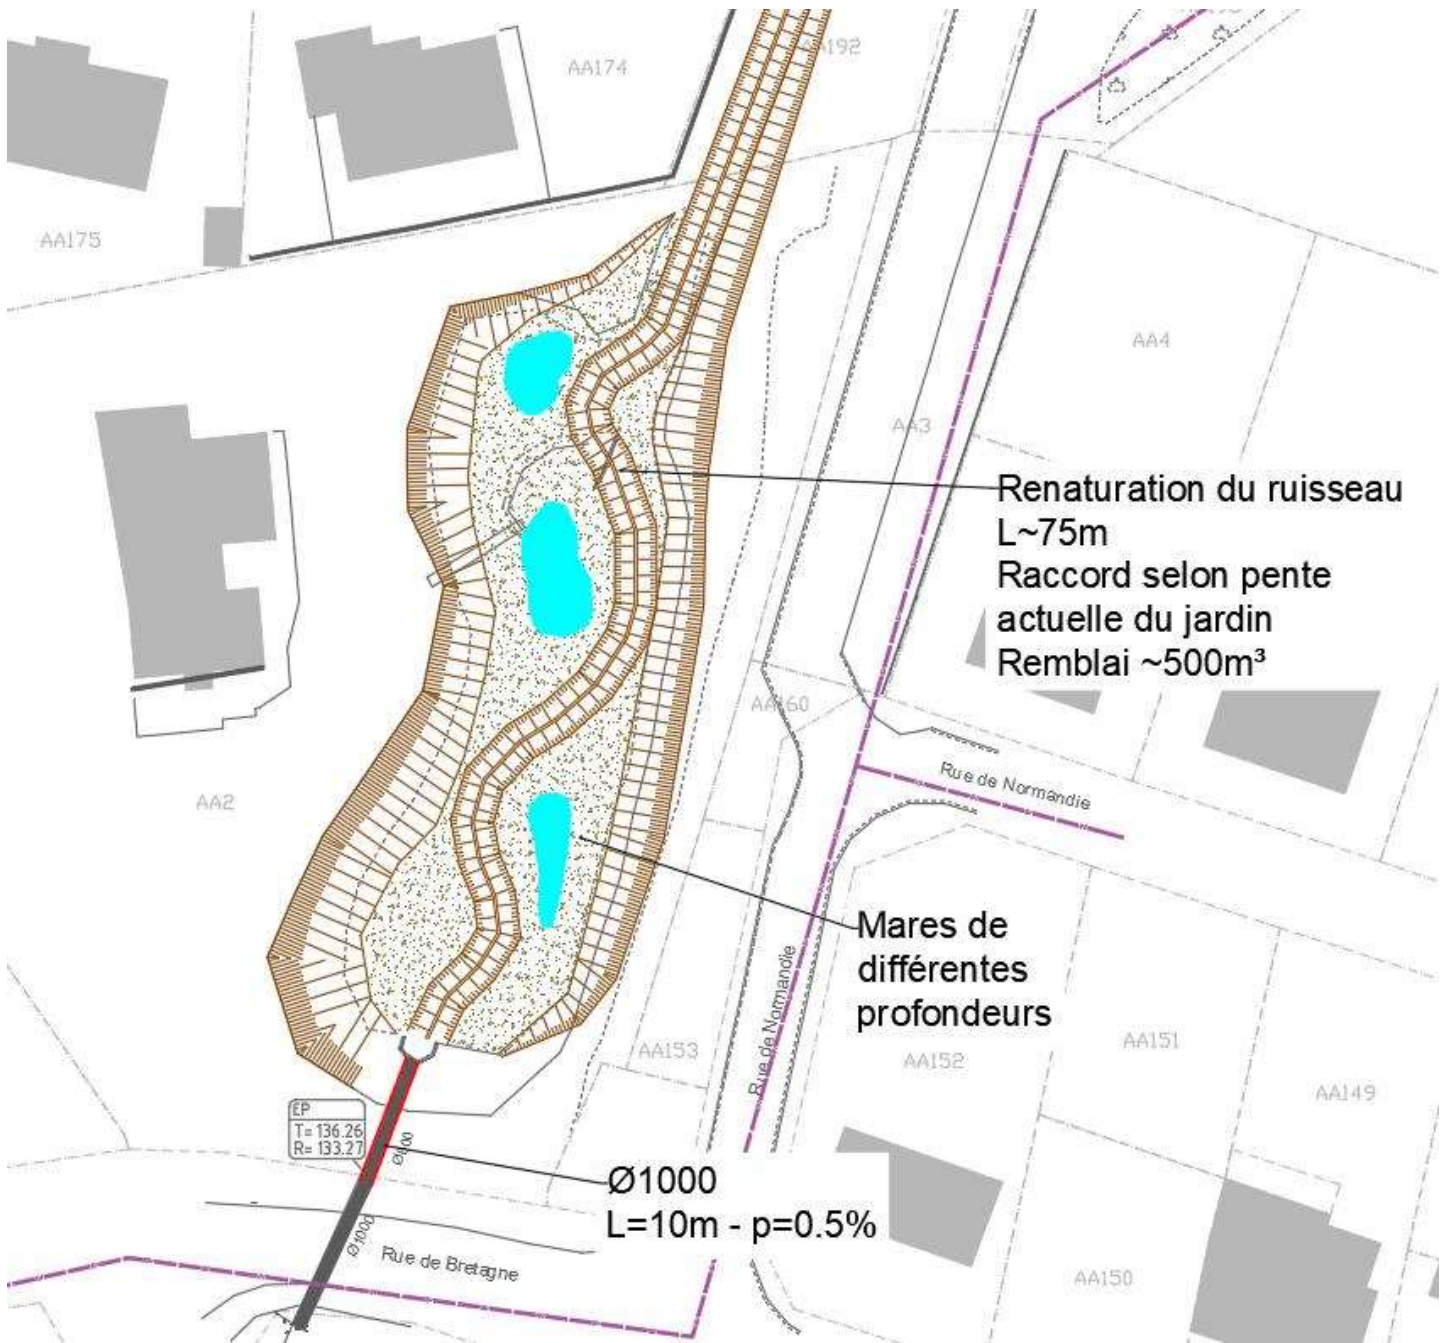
APS RCE 1, 2 et 3 – Vue en plan
